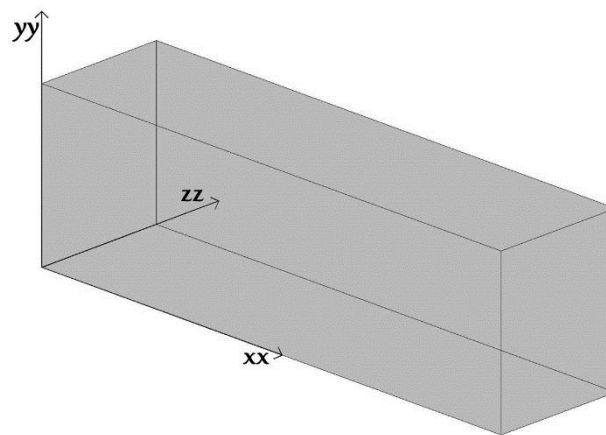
Sistema de coordenadas utilizado nas vigas de betão.
